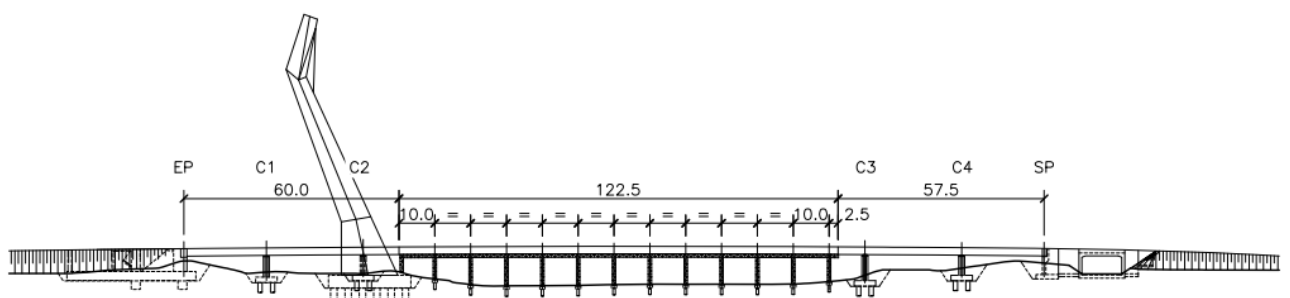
Construcción del vano principal sobre el río apoyado en torres provisionales pilotadas.
